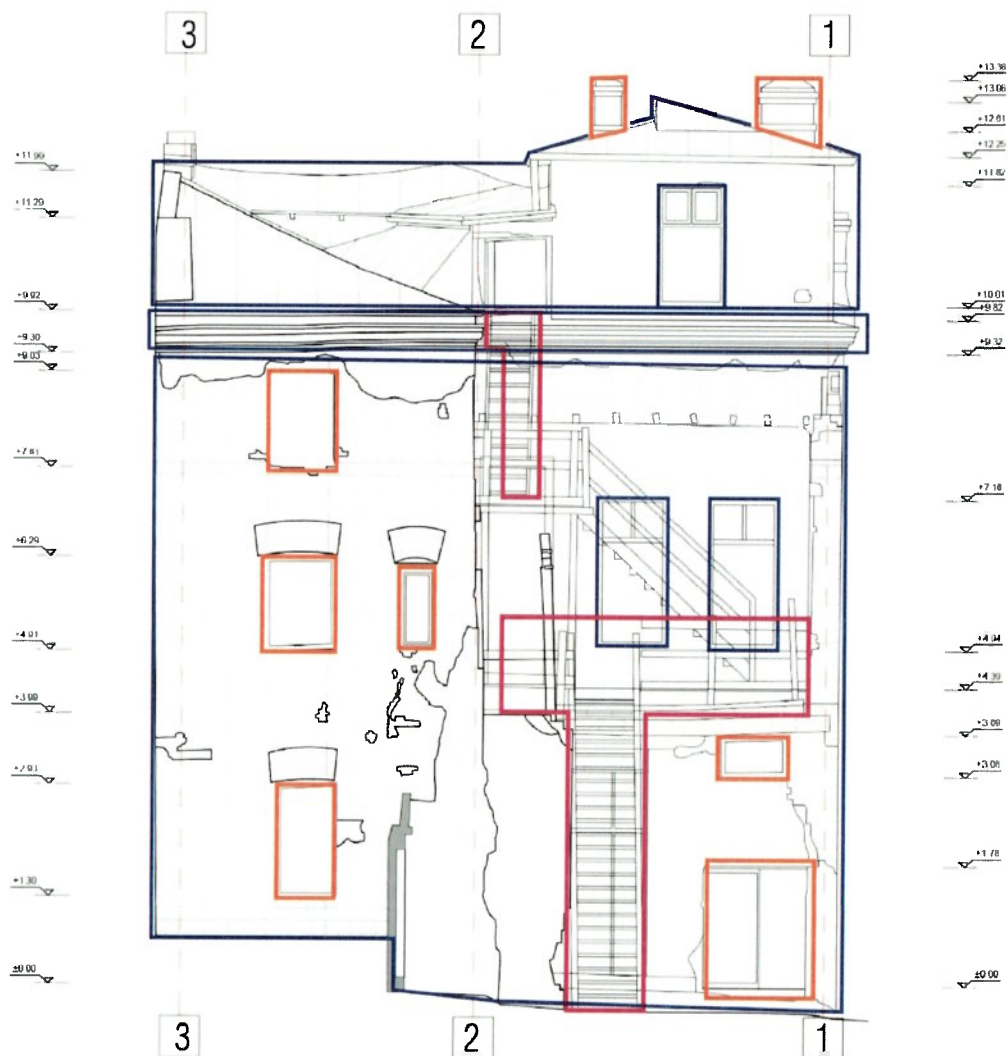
Fațadă posterioară (sud-est) – atitudini față de elementele construcției
